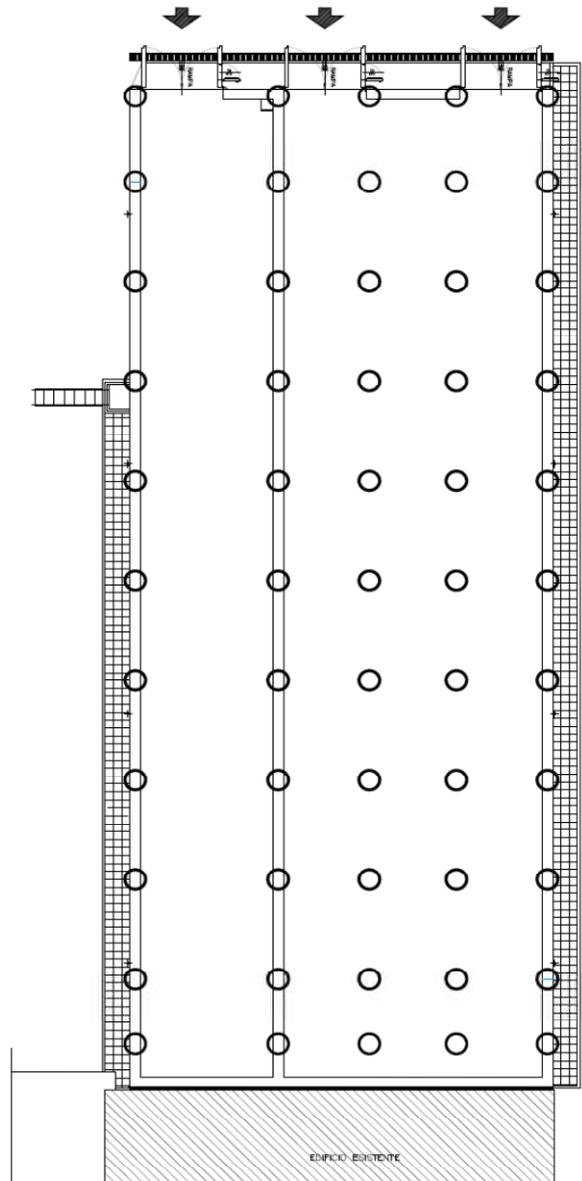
Pianta con posizionamento dei pali di fondazione
